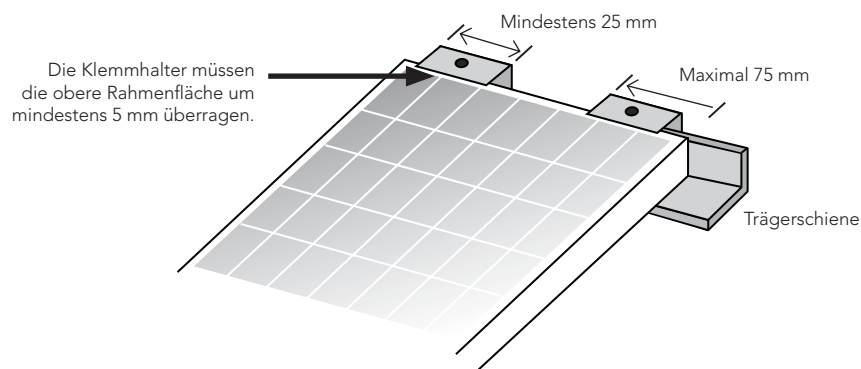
Jeder Modulrahmen wird einzeln per Klemmhalter befestigt
